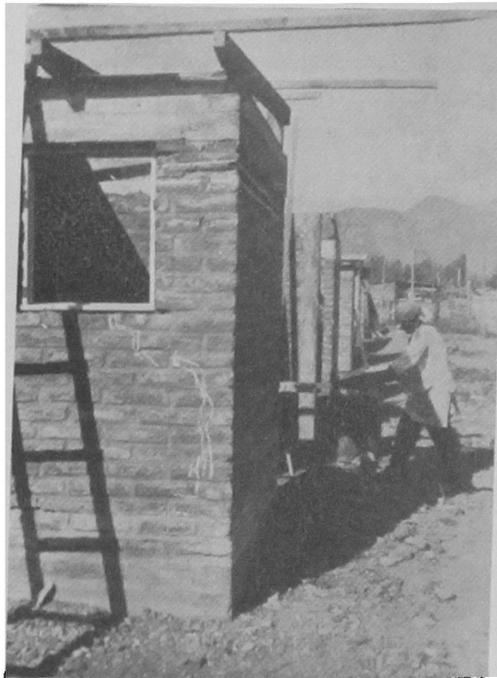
Daños en albañilerías de ladrillos con cadenas de hormigón armado y sin pilares, Los Andes
